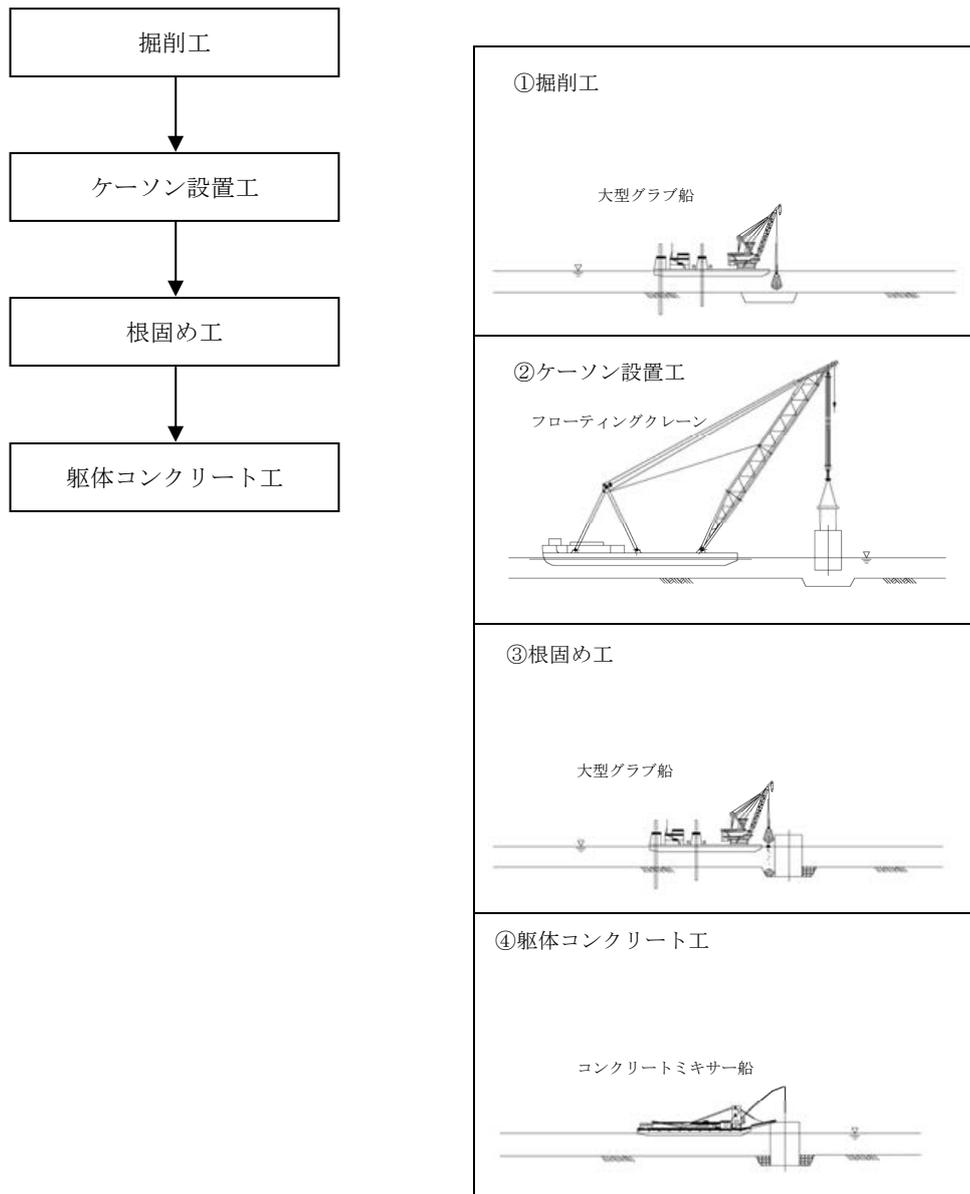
橋梁工（海上部、主塔基礎・橋脚基礎）の施工手順
